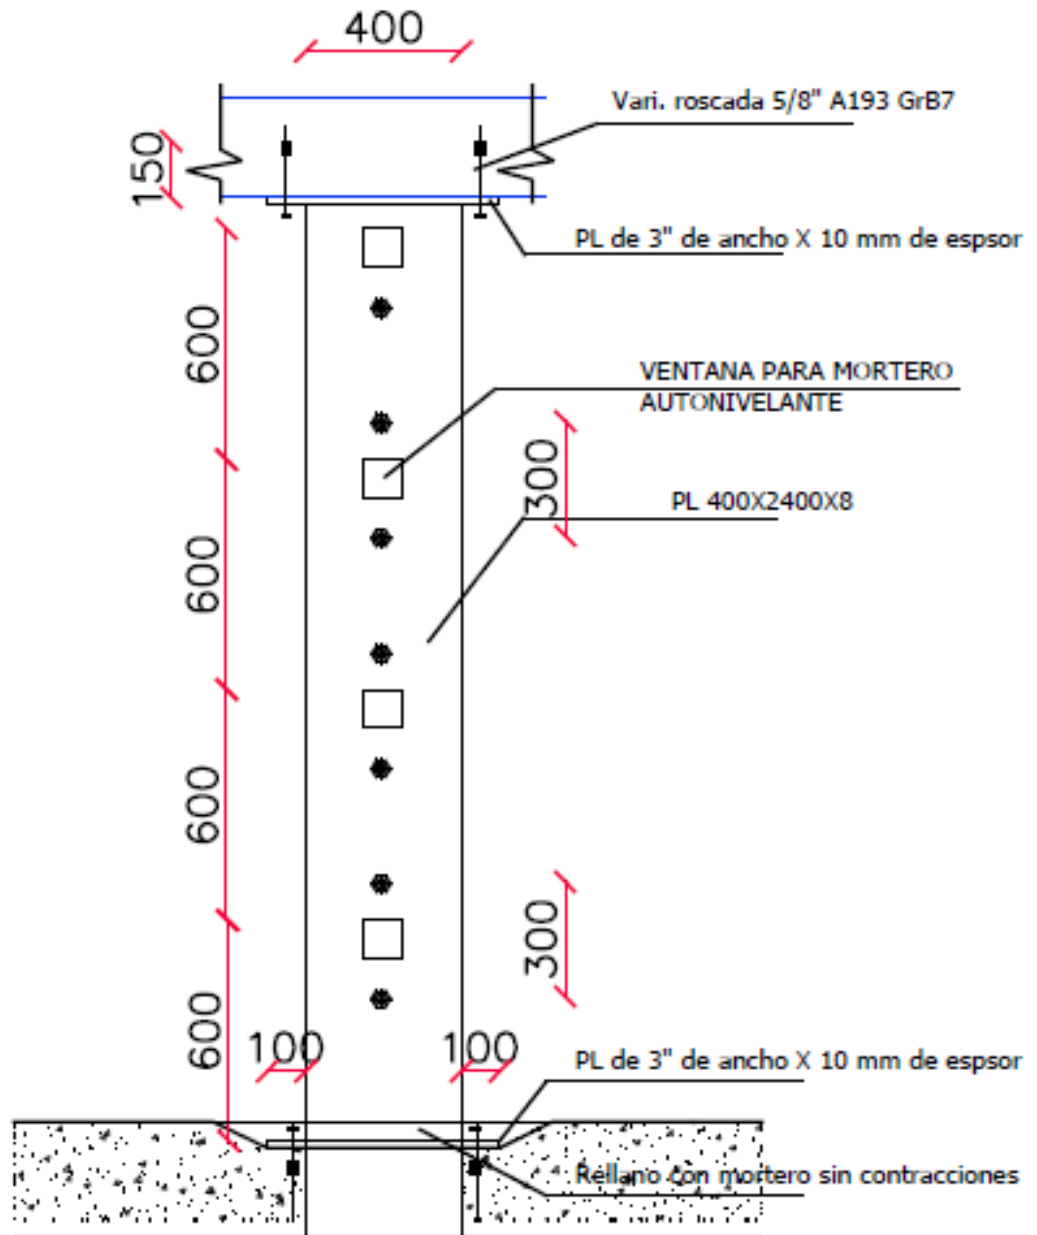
Detalle de la ubicación y corte de las platinas en las caras No 2 y 4.
